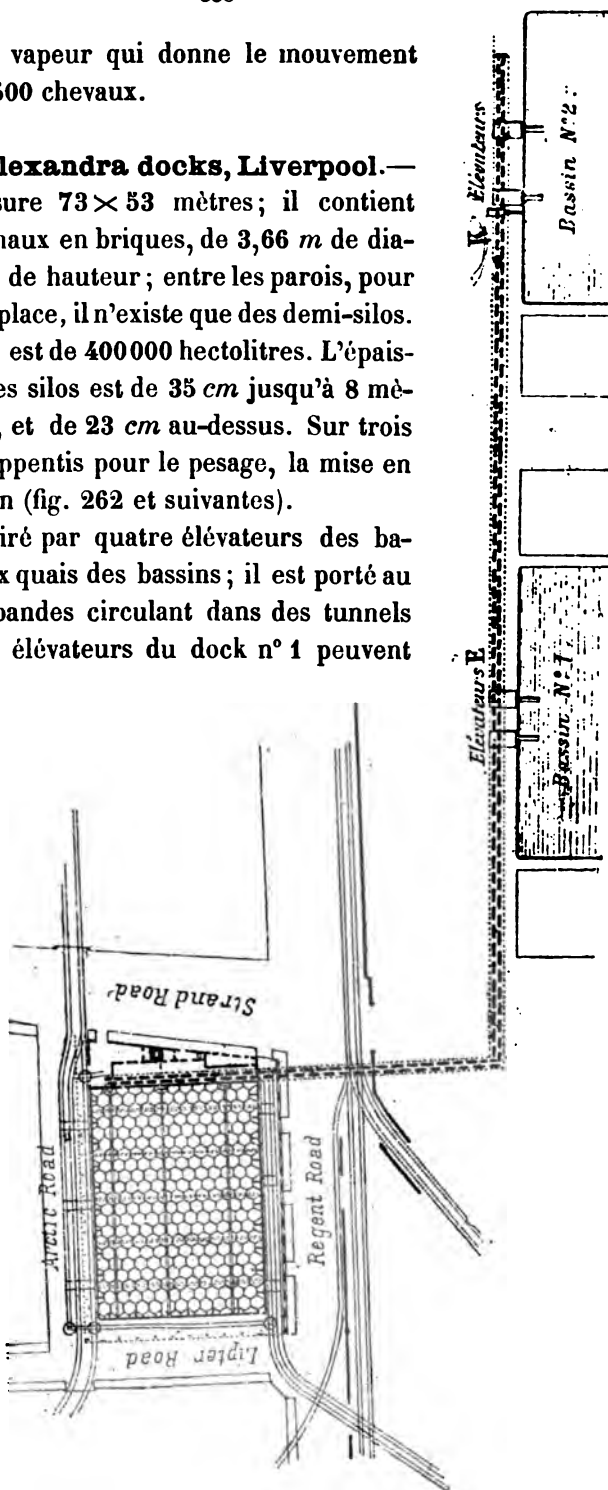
Alexandra docks, Grenier. Plan de l'ensemble.
